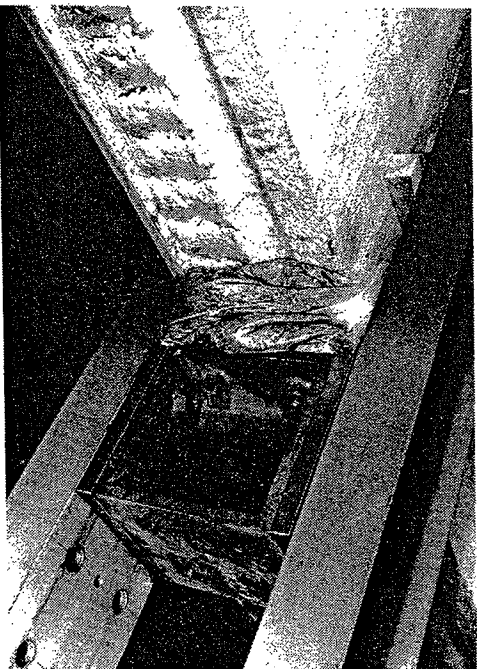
Fugebeton til hindring af deformationer på tværs
